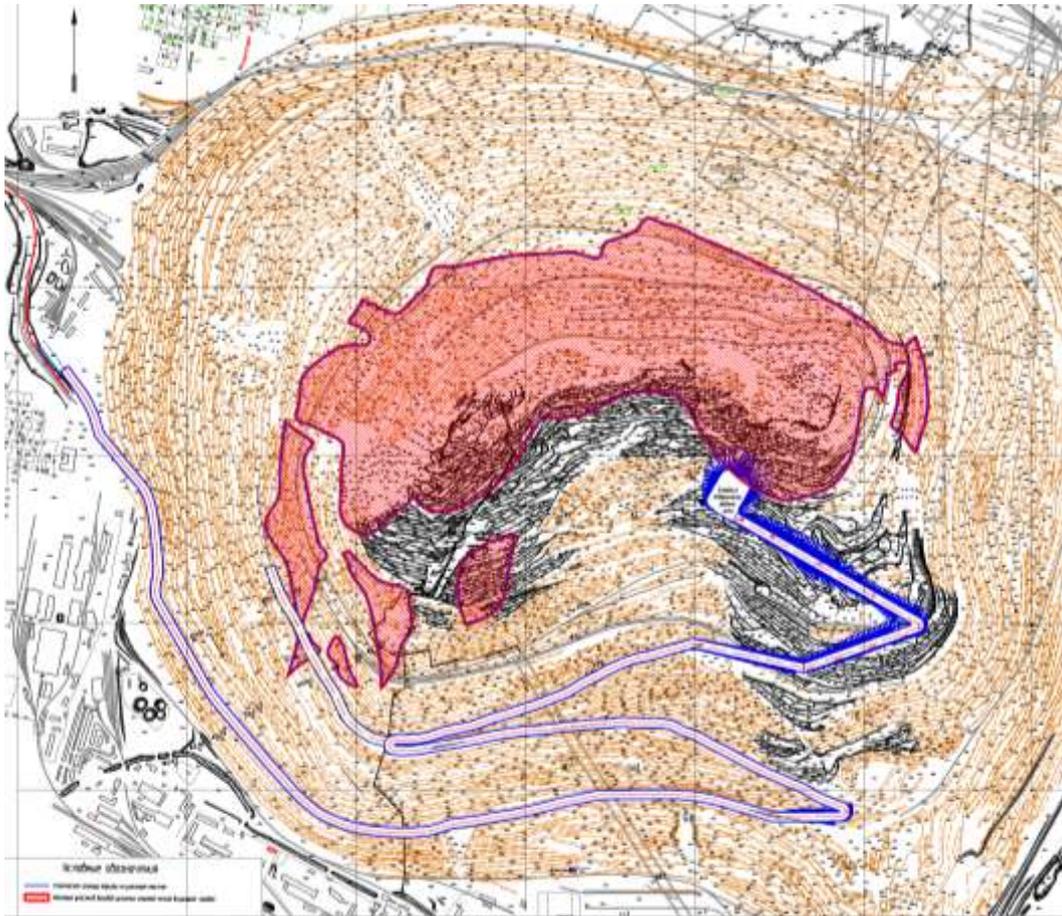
План угольного разреза на момент отработки балансовых запасов и изоляции выходов пластов в борт
